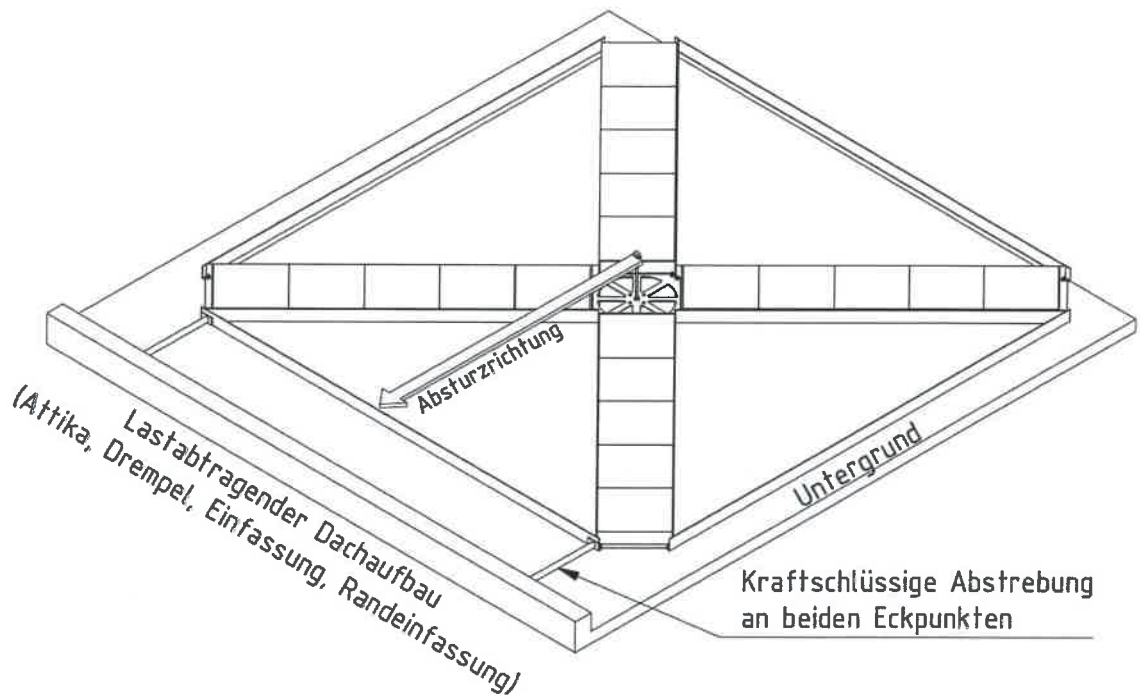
Lasteinleitung in den Baukörper (Variante 1 als zwei Einzellasten)
